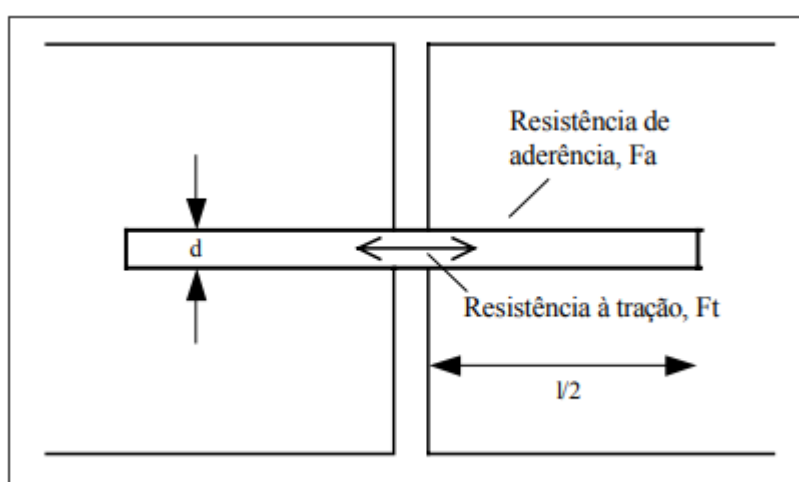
Disposição fibra/fissura idealizada
